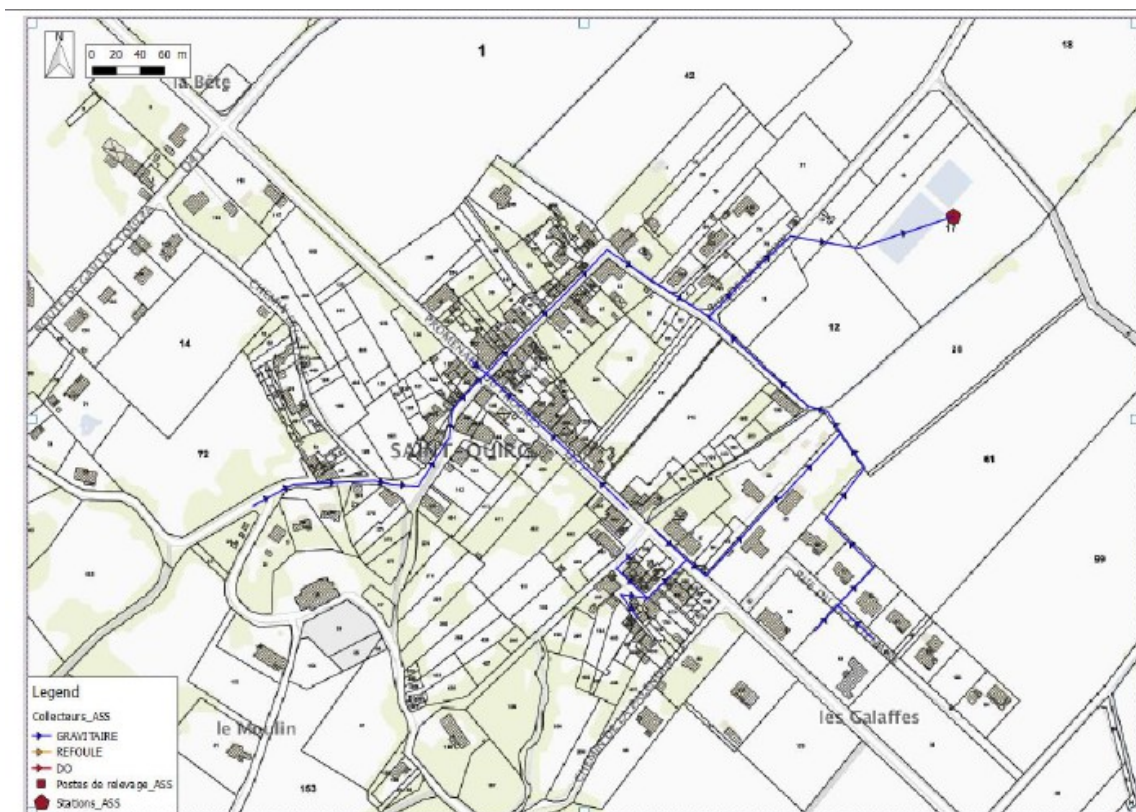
PLAN DU RESEAU D'ASSAINISSEMENT DE LA COMMUNE
